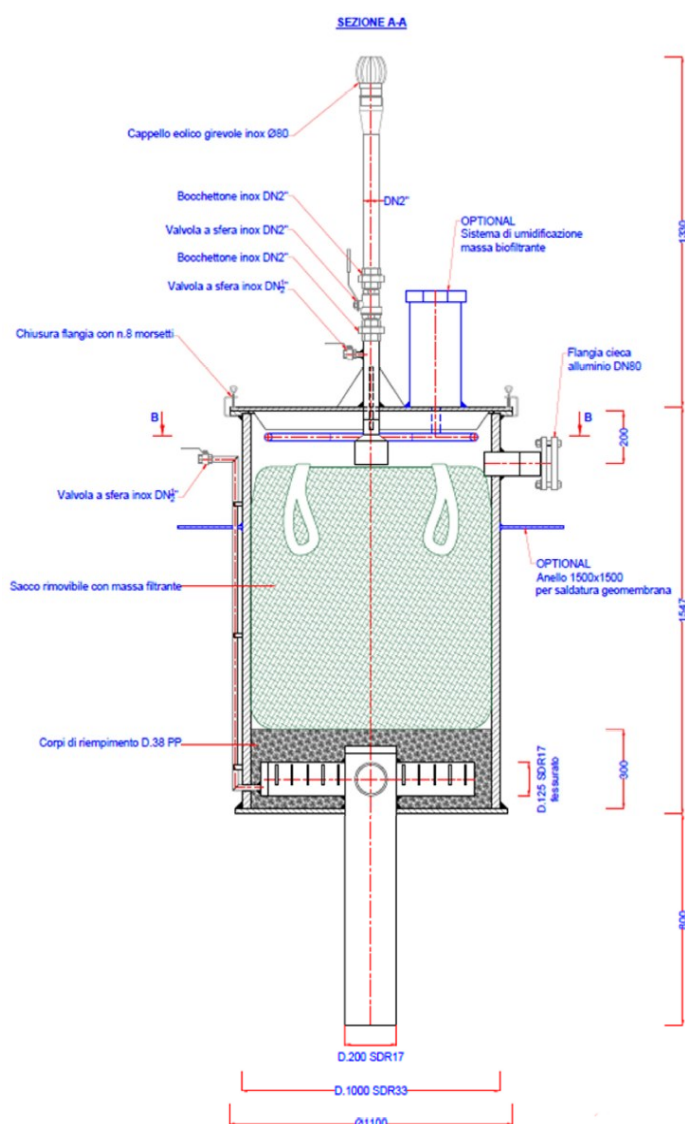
Sezione verticale testa pozzo biofiltrante (Stralcio elaborato grafico "TB.0_B_rev.2: Captazione biogas planimetria e particolari costruttivi").
